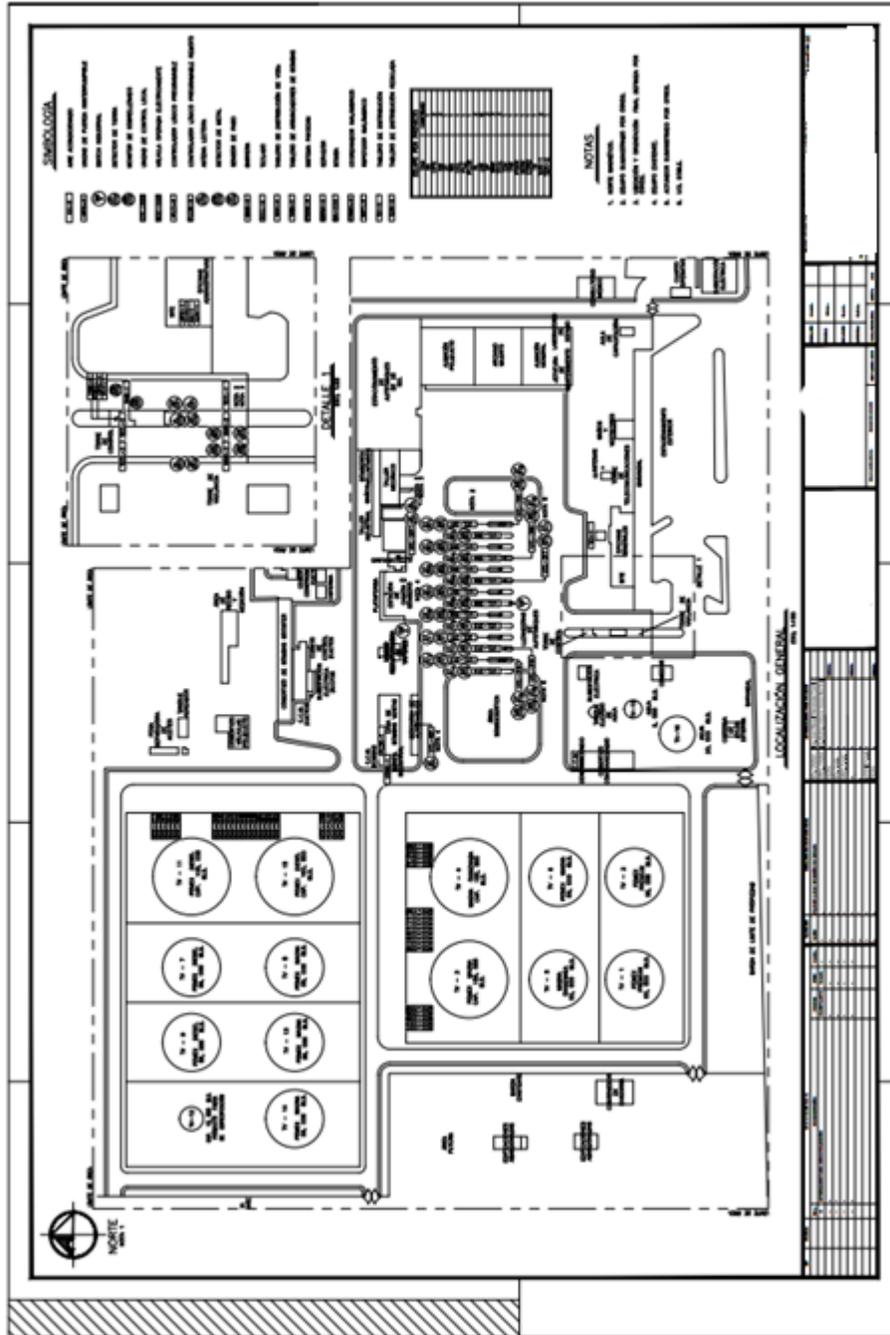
Plano De Localización General De Equipos (fuente: IIESA plano B-001).
